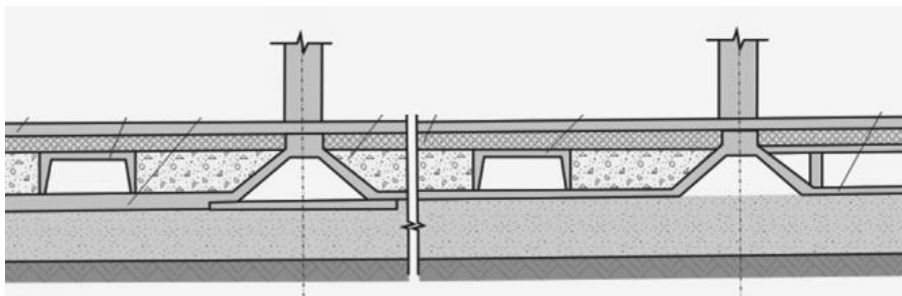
Вентиляционные каналы в толще грунтовых конструкций
